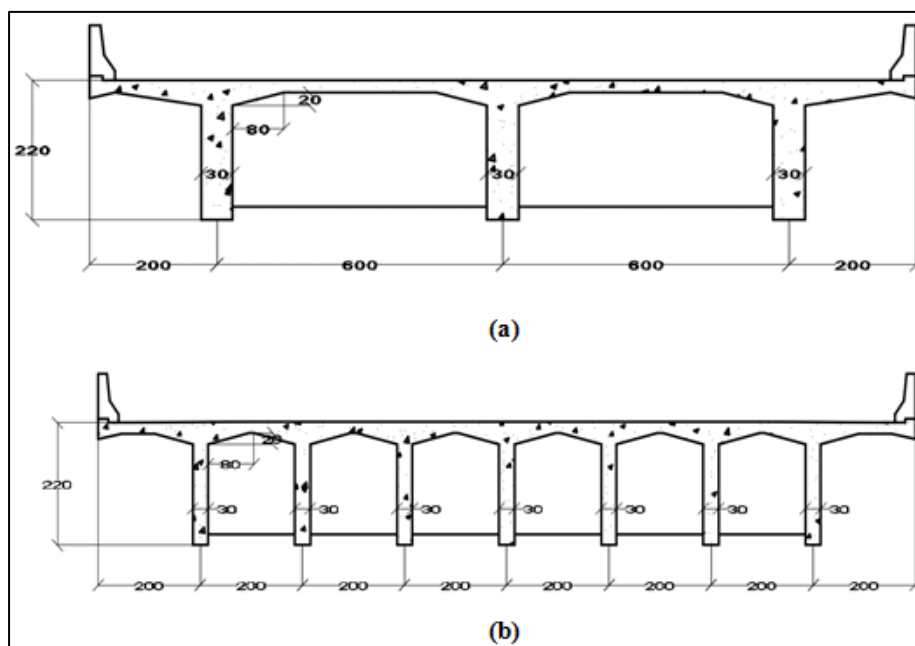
(a) Seção transversal da ponte com 3 longarinas - Meio do Vão; (b) Seção transversal da ponte com 7 longarinas - Meio do Vão.
